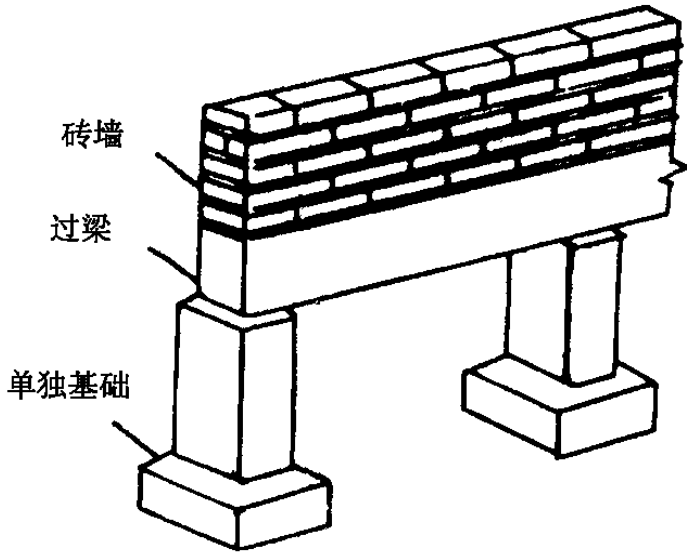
8 墙下单独基础（有钢筋混凝土过梁）
